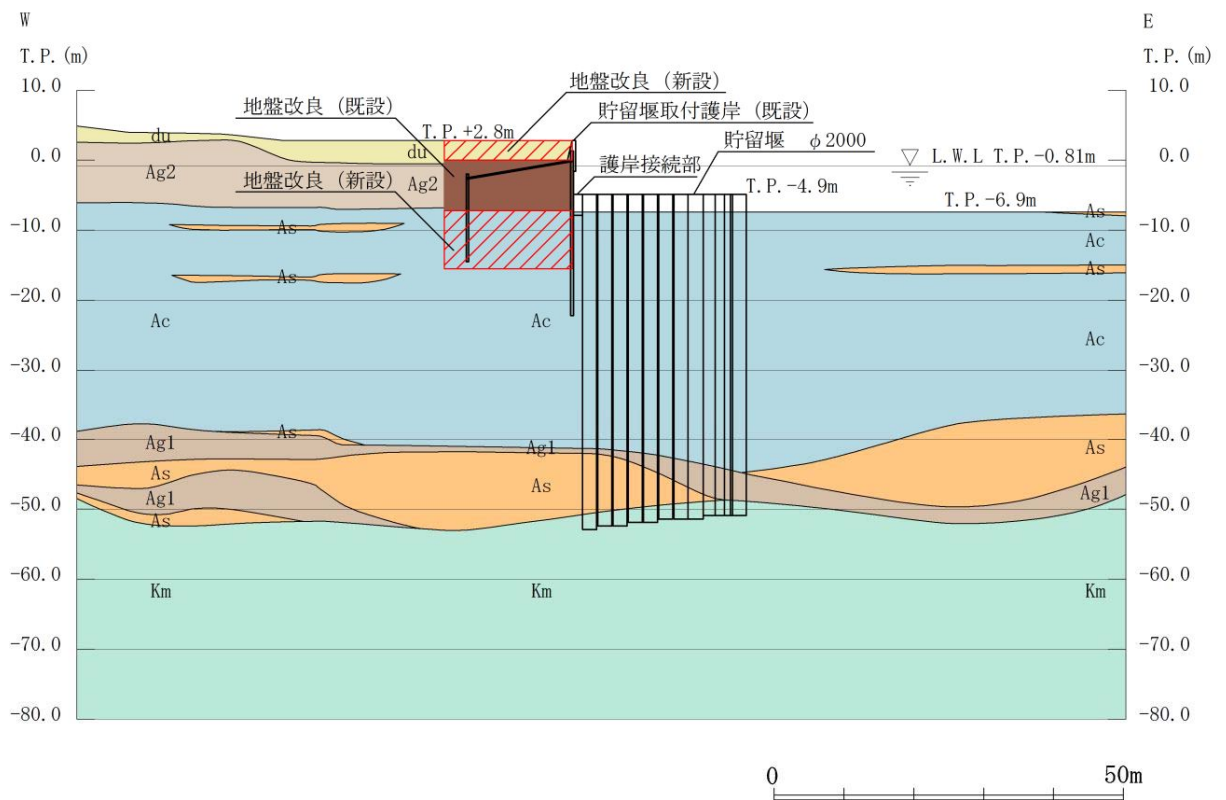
貯留堰取付護岸の断面図 (A-A 断面)
